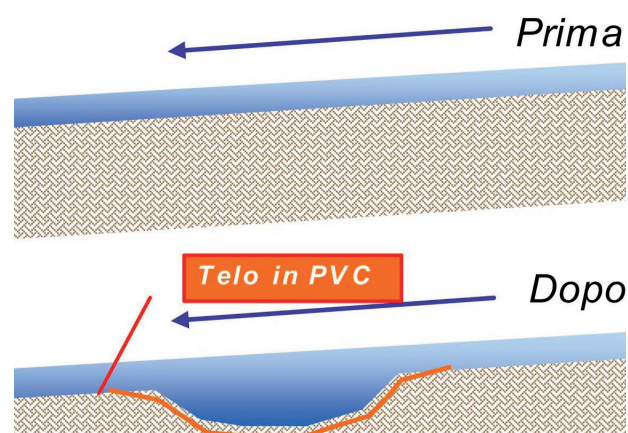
SEZIONE DI UN INTERVENTO TIPO.
